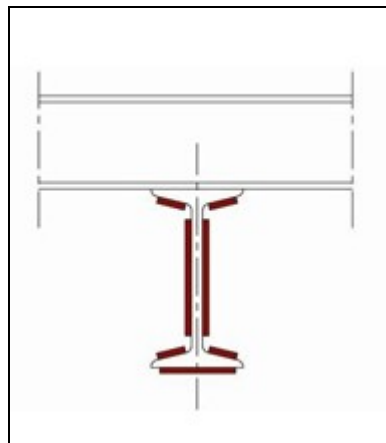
b Ajout de plats soudés, semelles et âme
